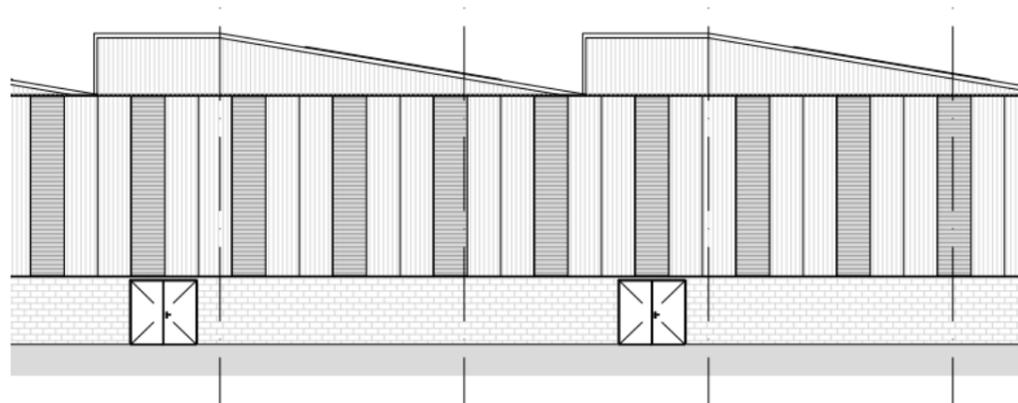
Distribución de los paneles de policarbonato en la fachada de paneles sándwich
